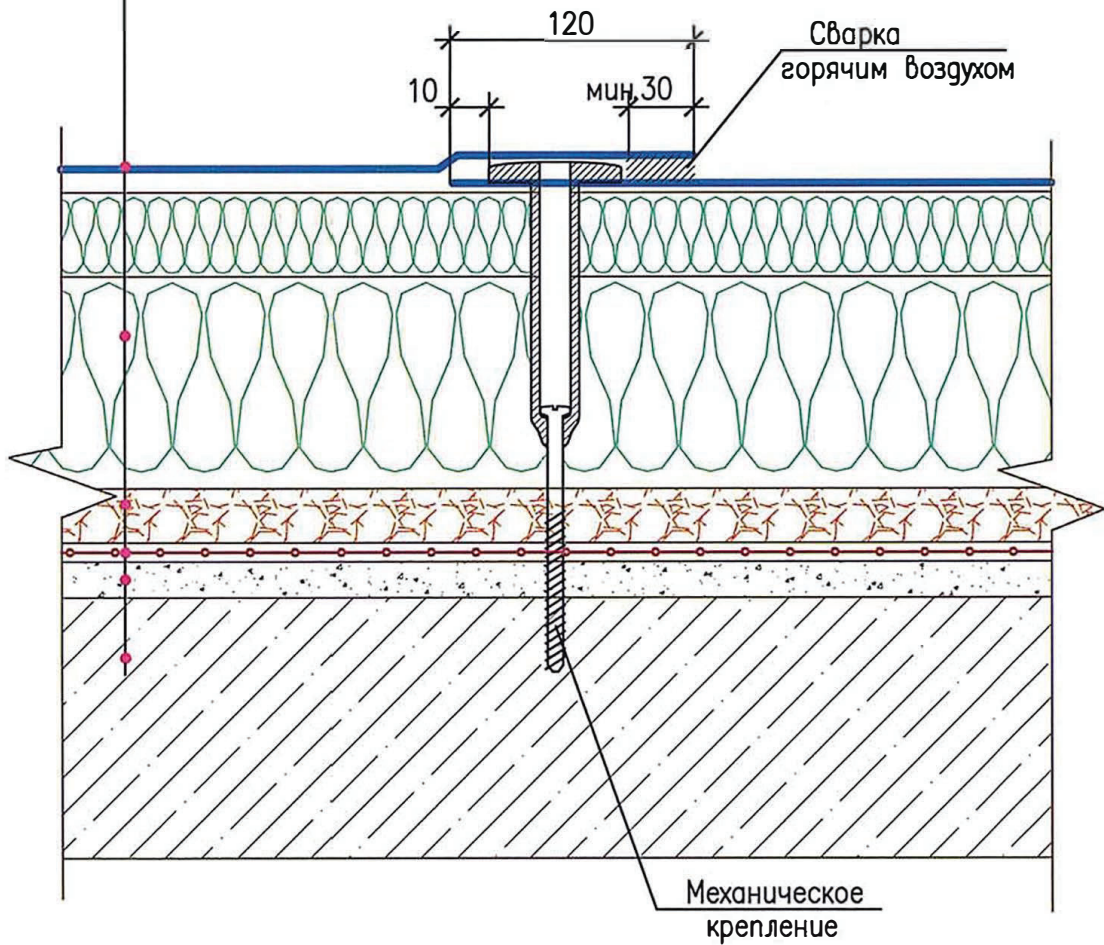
Механическое закрепление к железобетонному основанию. Структура покрытия
